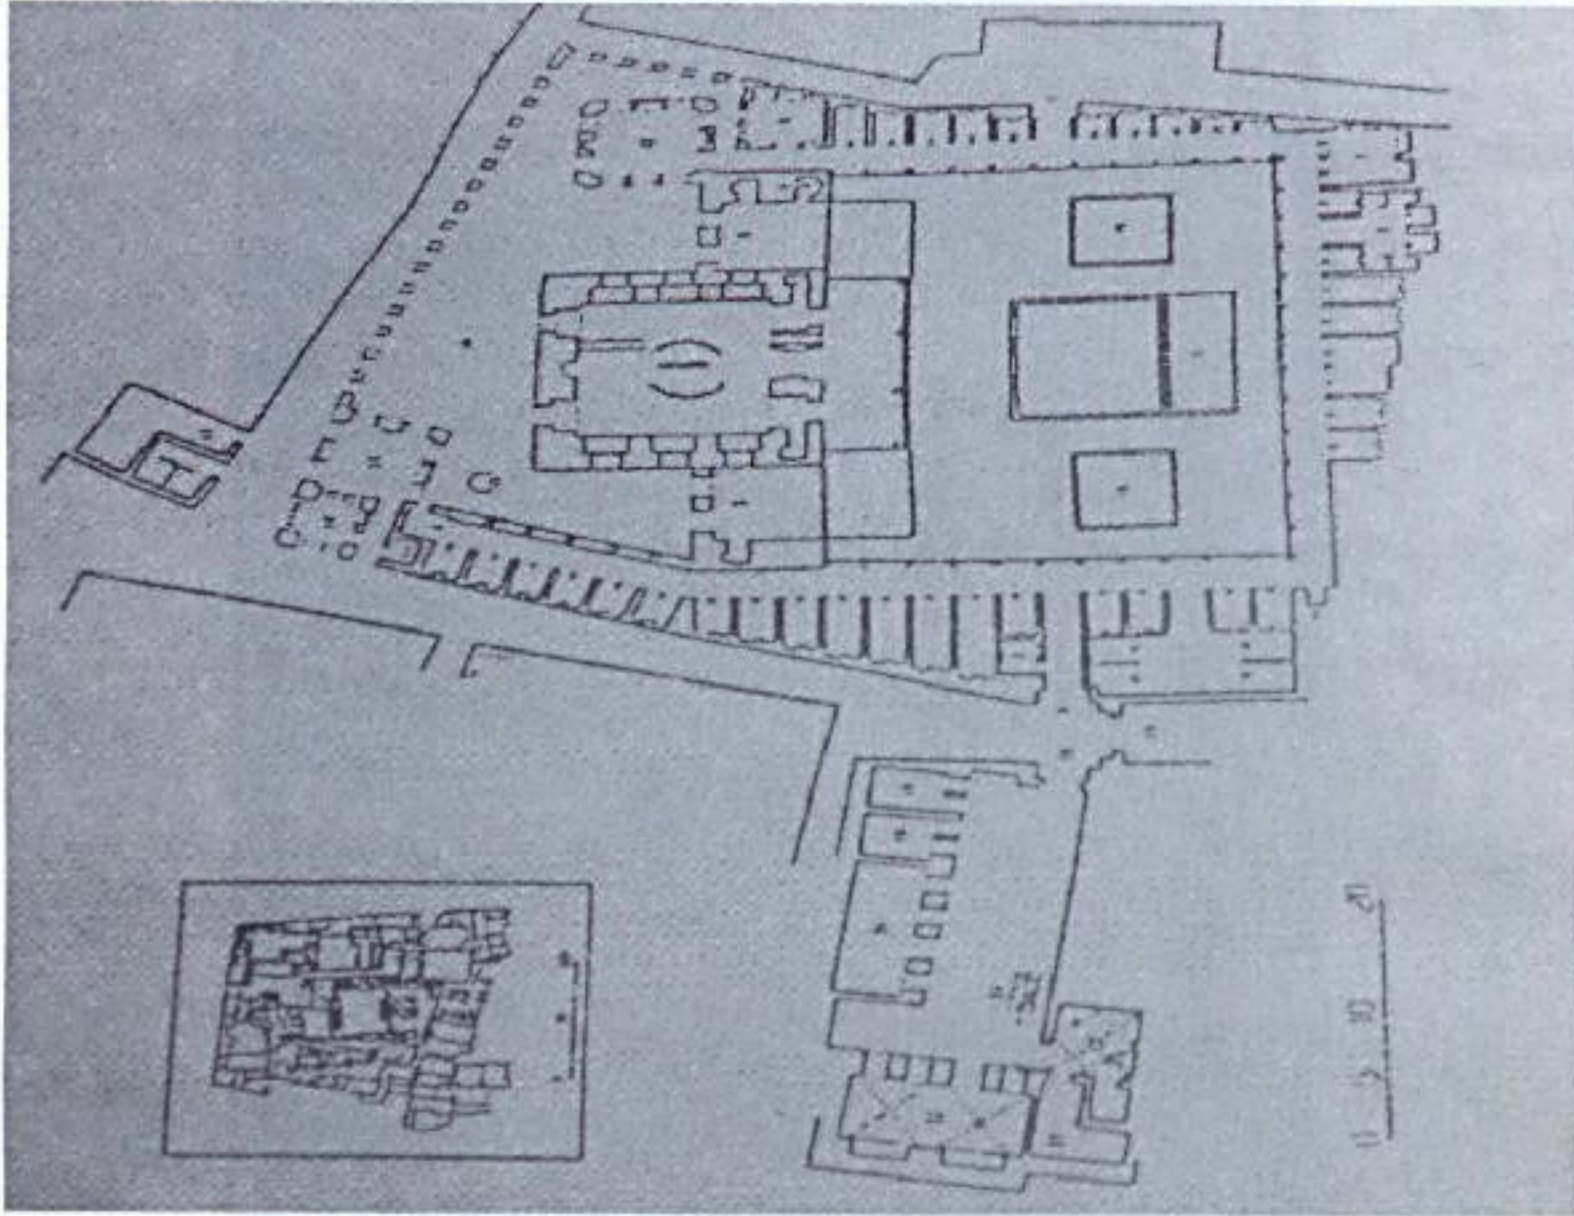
مسقط أفقي لمسجد خسرو باشا ضمن مجمعه بحلب، نقلا عن جودين
